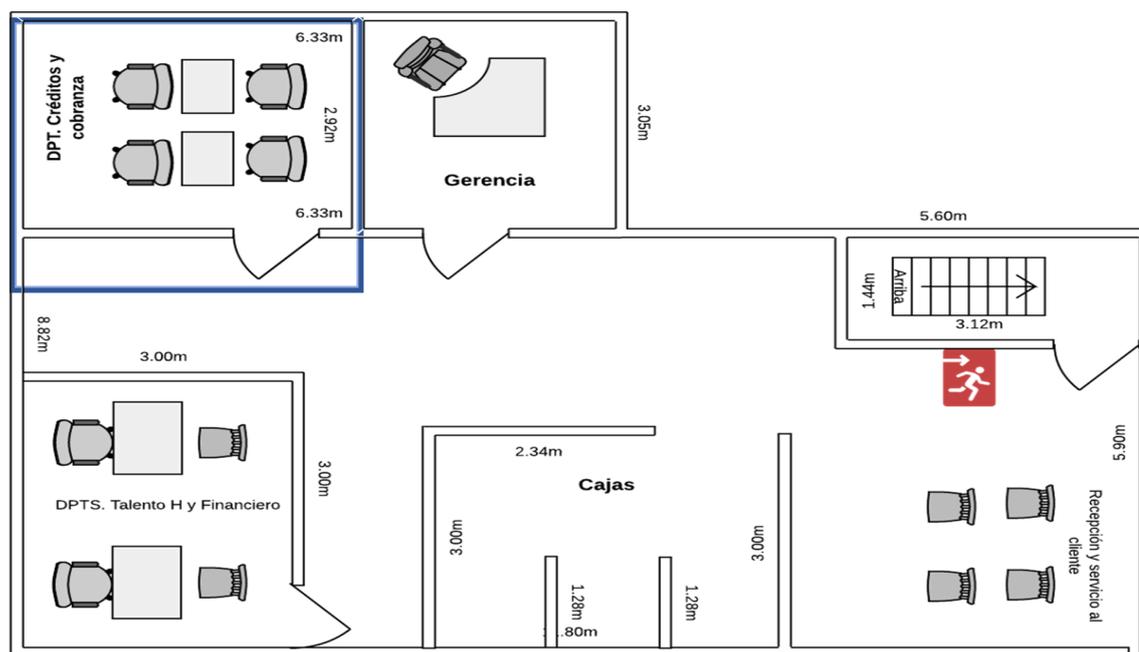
Distribución de la planta COAC P.A.I.S.
